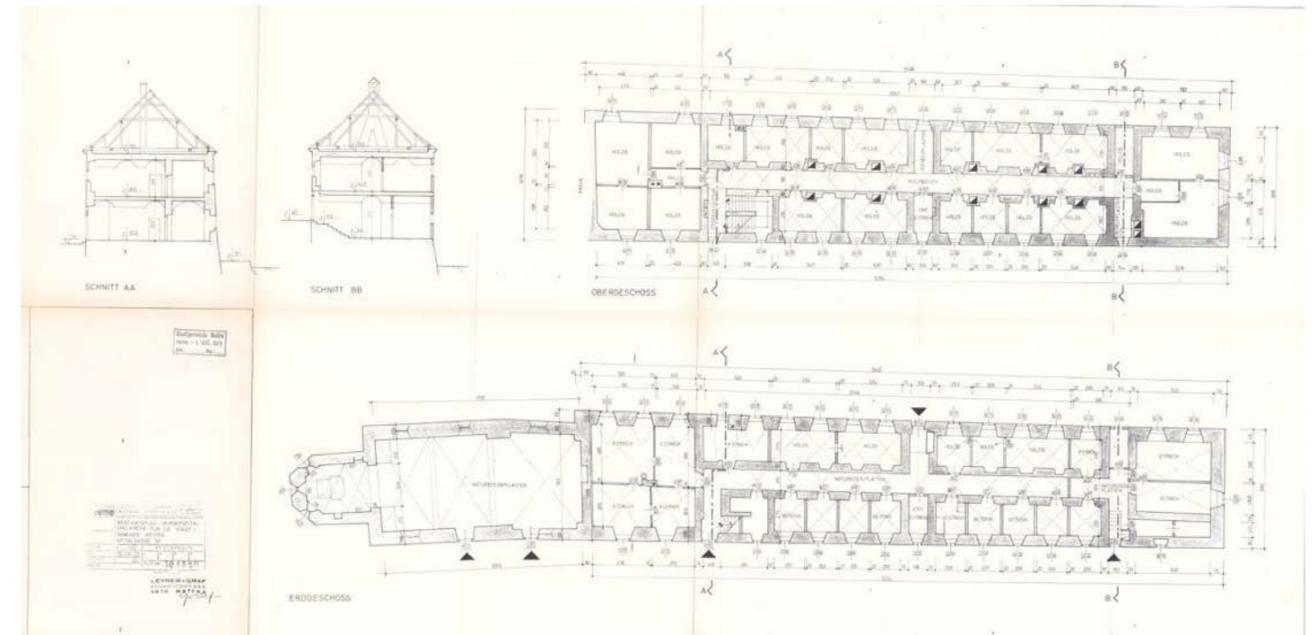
Bestandsplan. Grundrisse, Schnitte des Bürgerspitals und der Kirche. LEYRER+GRAF Baugesellschaft M.B.H, 1979
